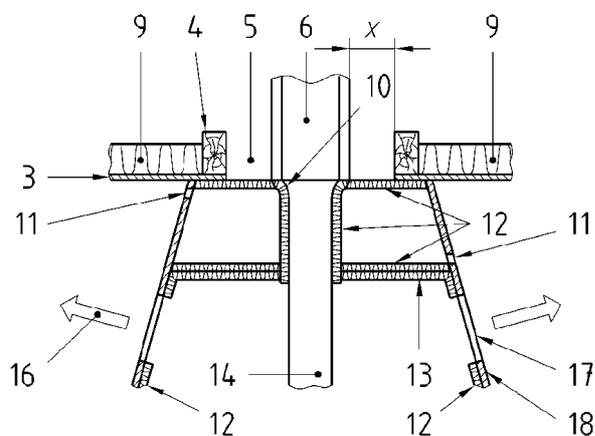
Exemple de raccordement d'un âtre sur un conduit de fumée existant de grande section ou évasé en partie basse
